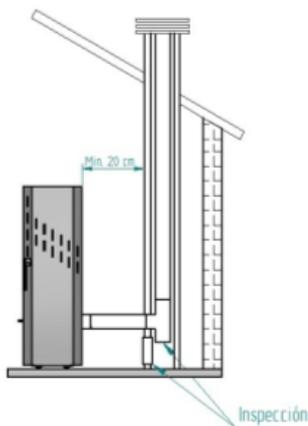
Vista lateral da instalação com chaminé, com exemplo do ponto de inspecção.
